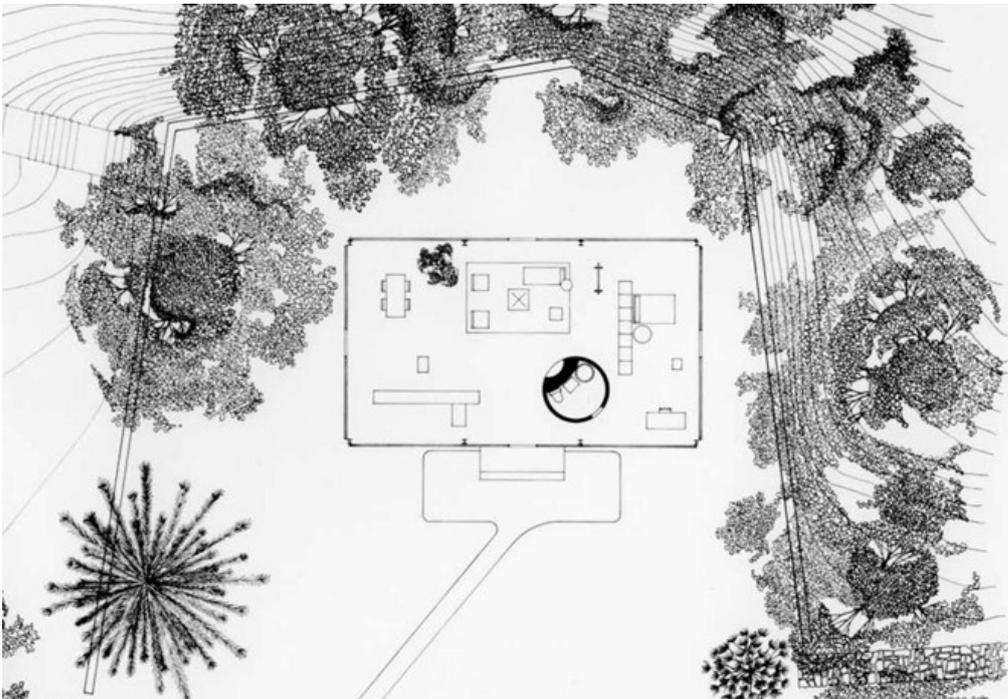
Glass House, Grundriss, Quelle: <http://philipjohnsonglasshouse.org>
